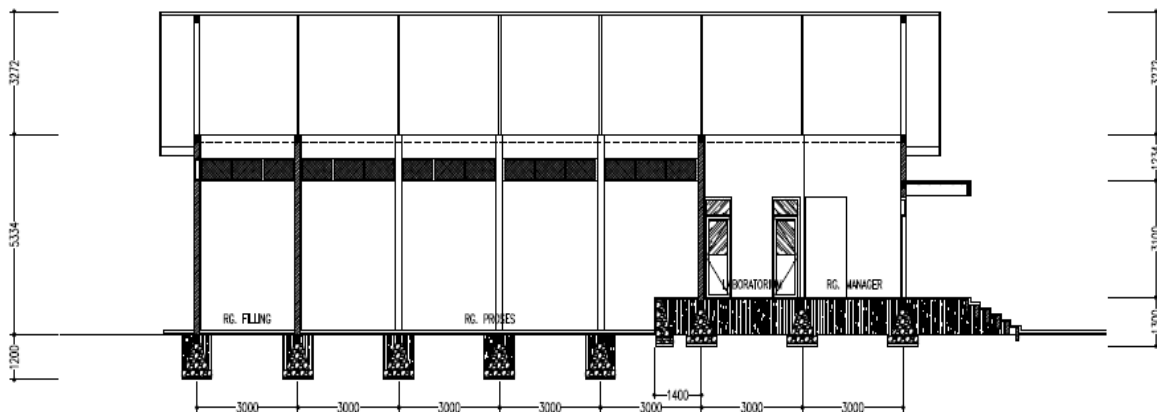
Denah Bangunan Proses Susu Sterilisasi
